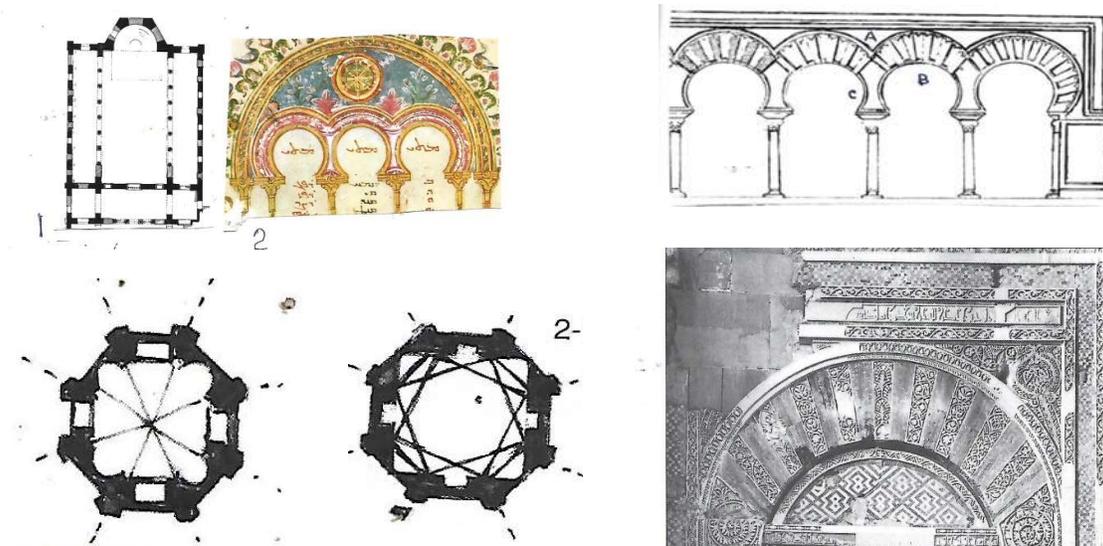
Córdoba y Bizancio. Bizantinismo. 1, la planta bizantina anterior; 2, tribelón de la miniatura bizantina; 3, planta del baptisterio de San Lorenzo de Milán; 4, planta del segundo cuerpo de la qubba central de la maqsura, mezquita aljama de Córdoba, ambas plantas con refuerzo en las esquinas. A la derecha, esquema de arquería de la nave central del Salón Rico de al-Zahra con A, B, C, albanegas, dovelas y salmeres con decoración. Este tipo de arcos así decorados patente en el arco de la derecha de la mezquita aljama de Córdoba del siglo X, antes en la Puerta de San Esteban del mismo oratorio.
